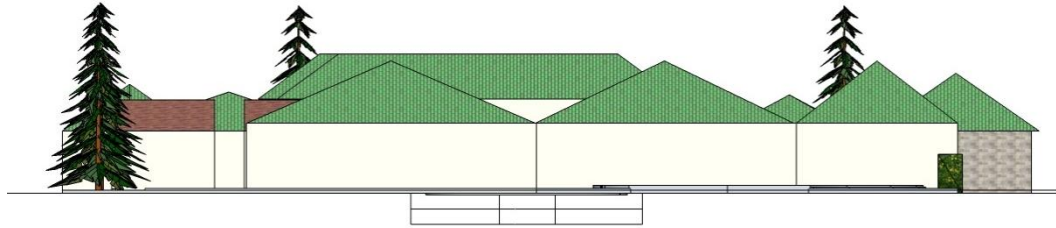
Tampak Barat bangunan YPAC Surakarta setelah redesign
